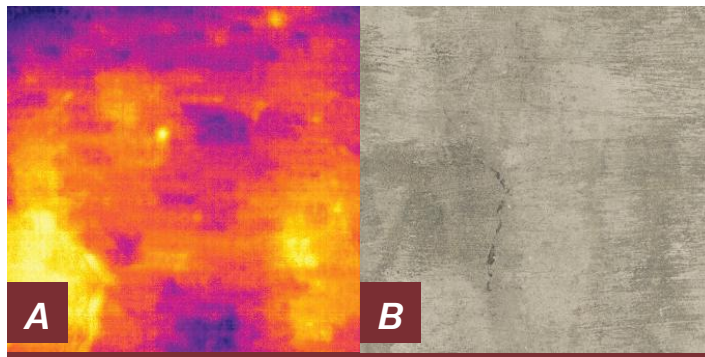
Una zona específica del pilar 30 con una grieta: (a) imagen IR y (b) imagen HRI.
